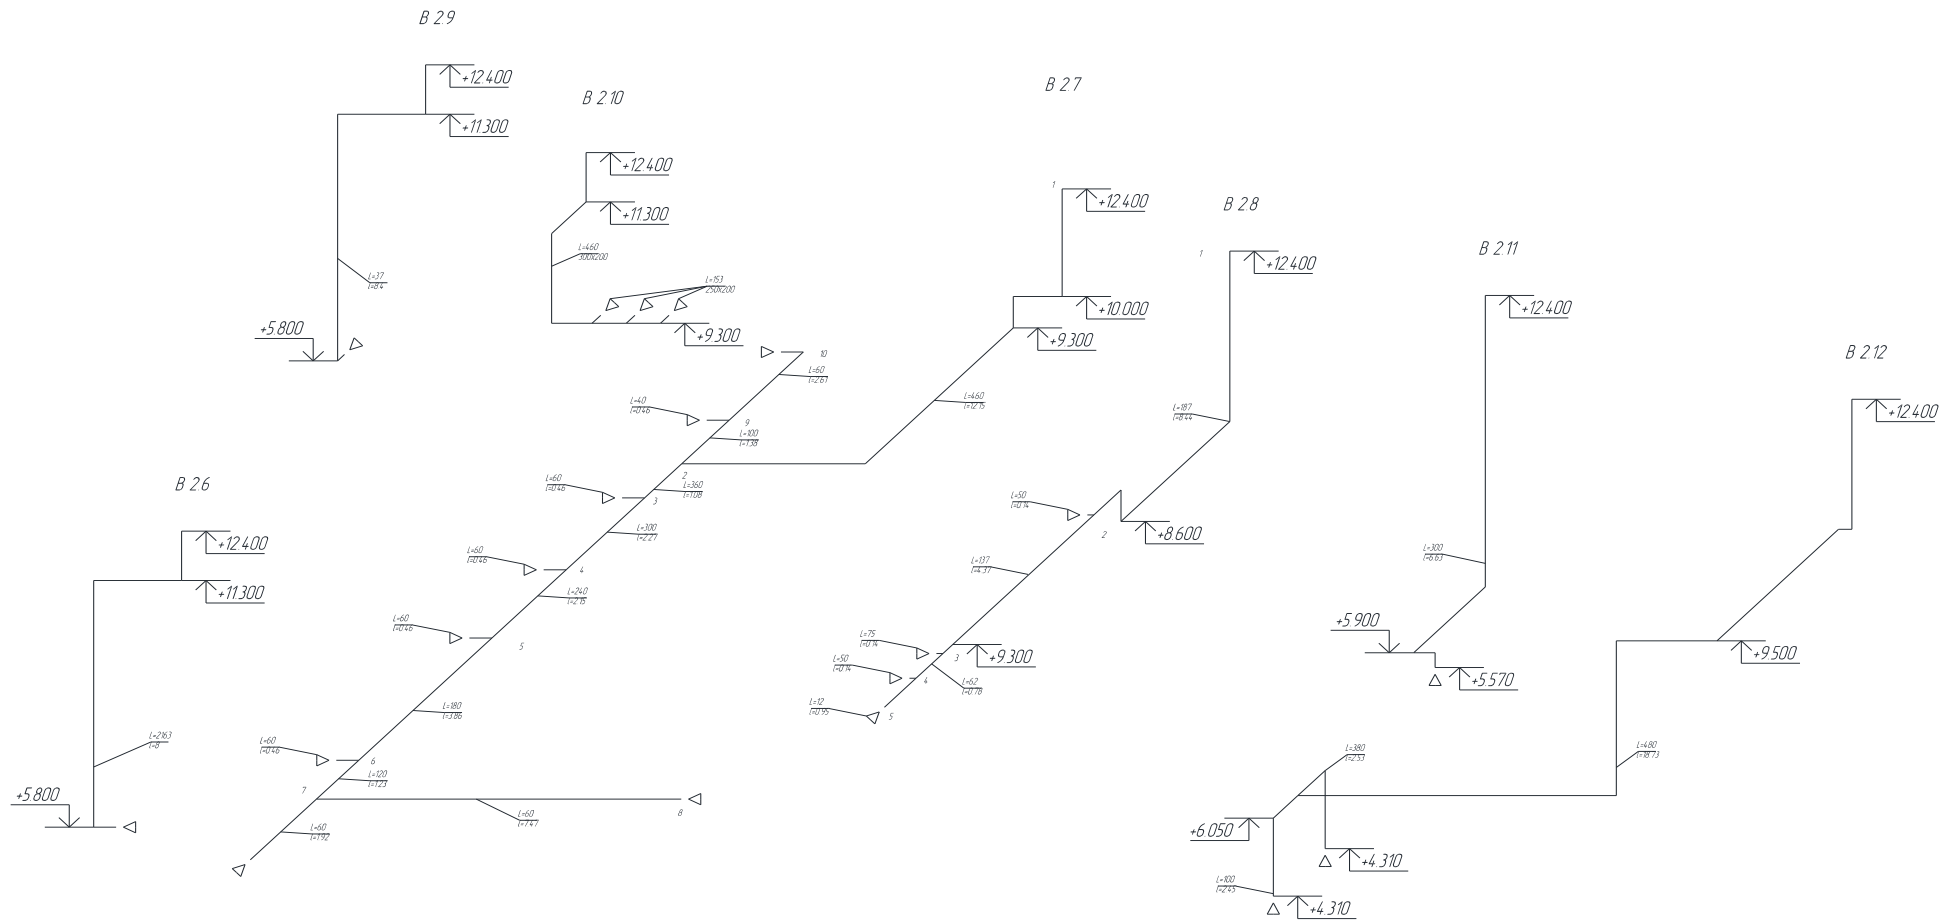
Расчетные схемы систем вентиляции блока №2
